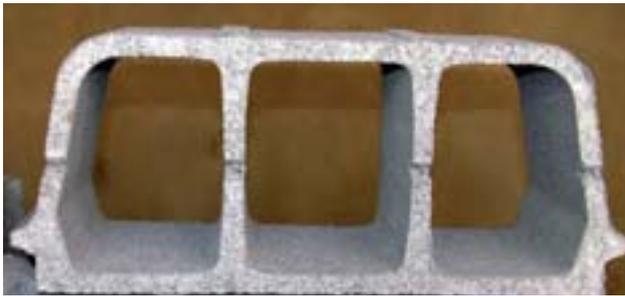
Imagen bovedilla de hormigón prefabricado.
